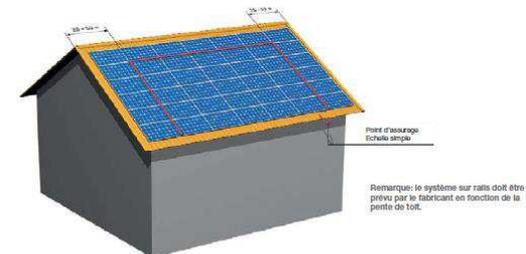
Exemple de protection contre les chutes avec système sur rails
